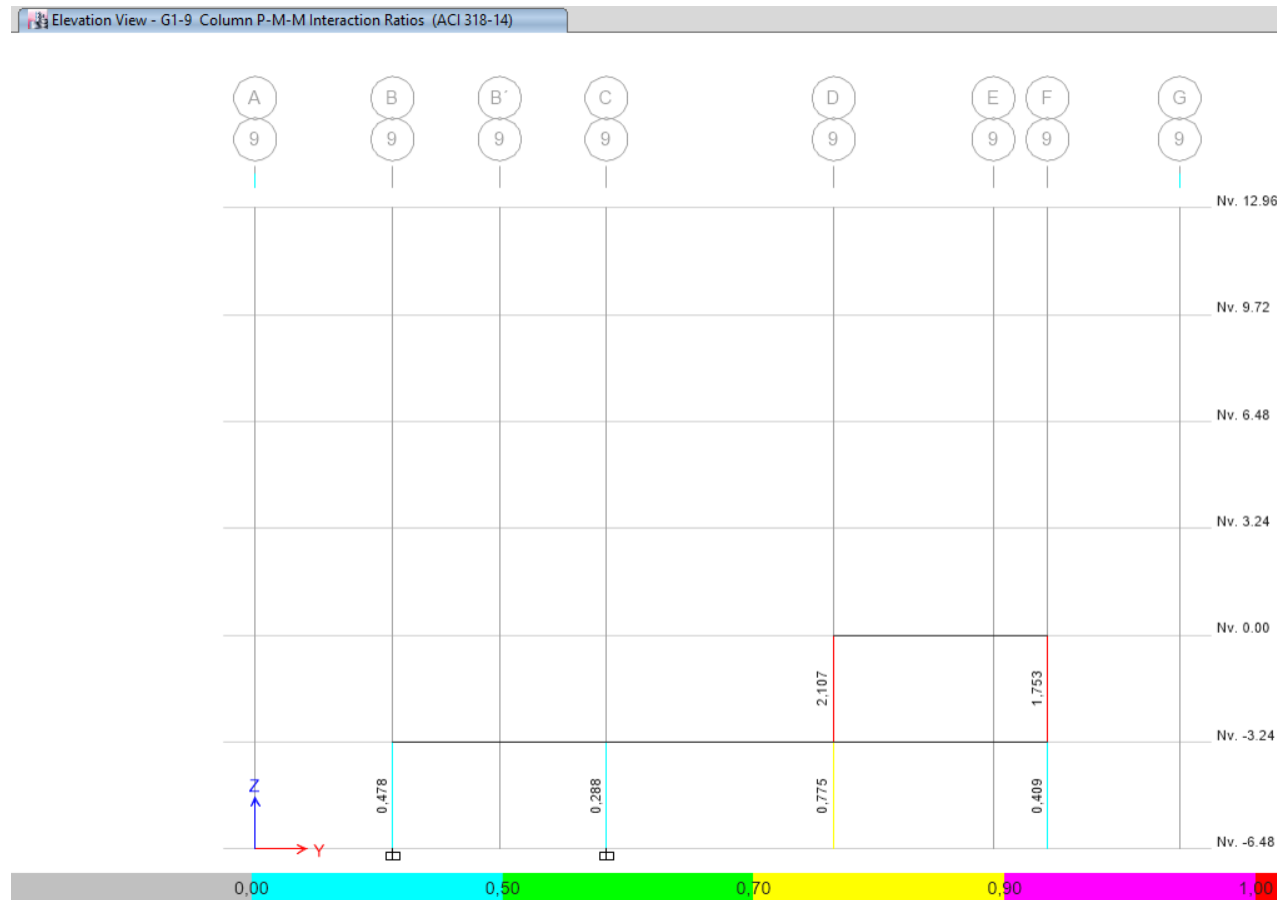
Vista en elevación de la demanda/capacidad en columnas, pórtico eje 8.
